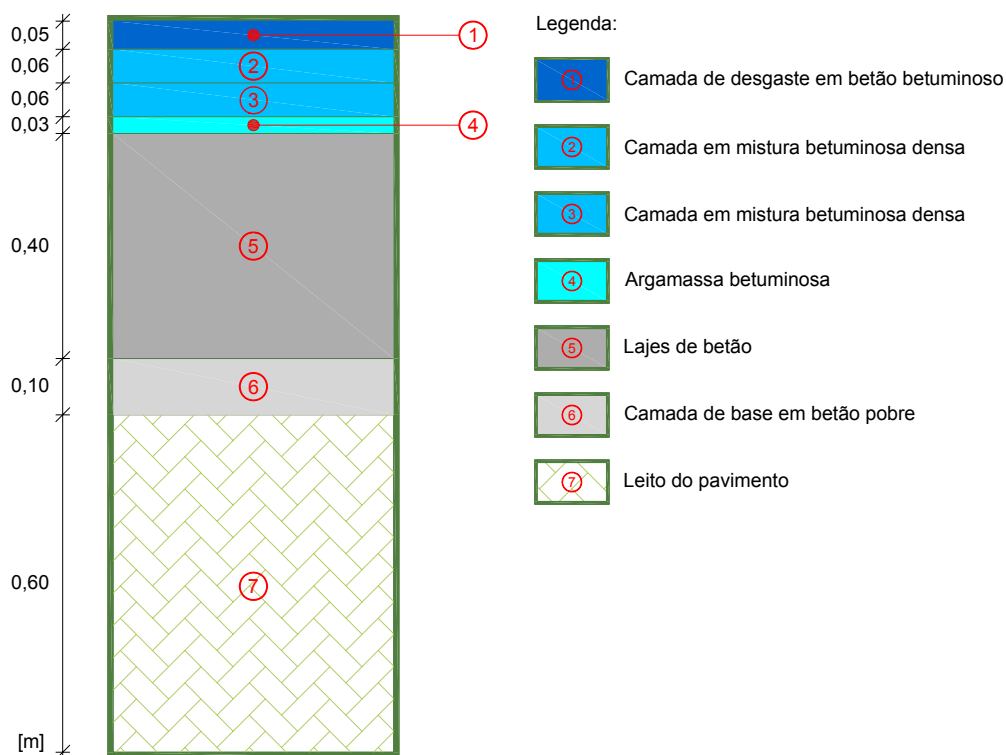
Estrutura do pavimento rígido mais reforço em camadas betuminosas
